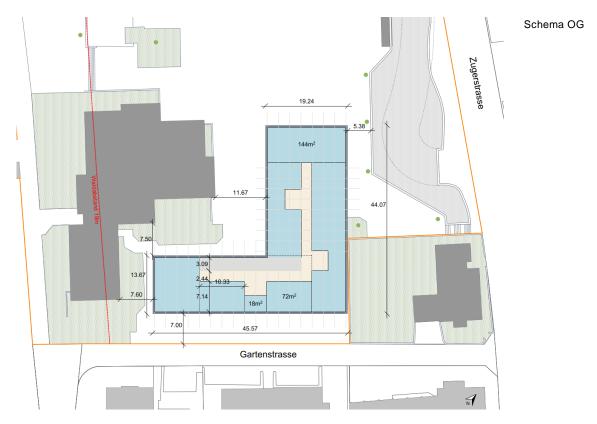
Variante Ersatzneubau Gartenschulhaus – Schema Obergeschoss
